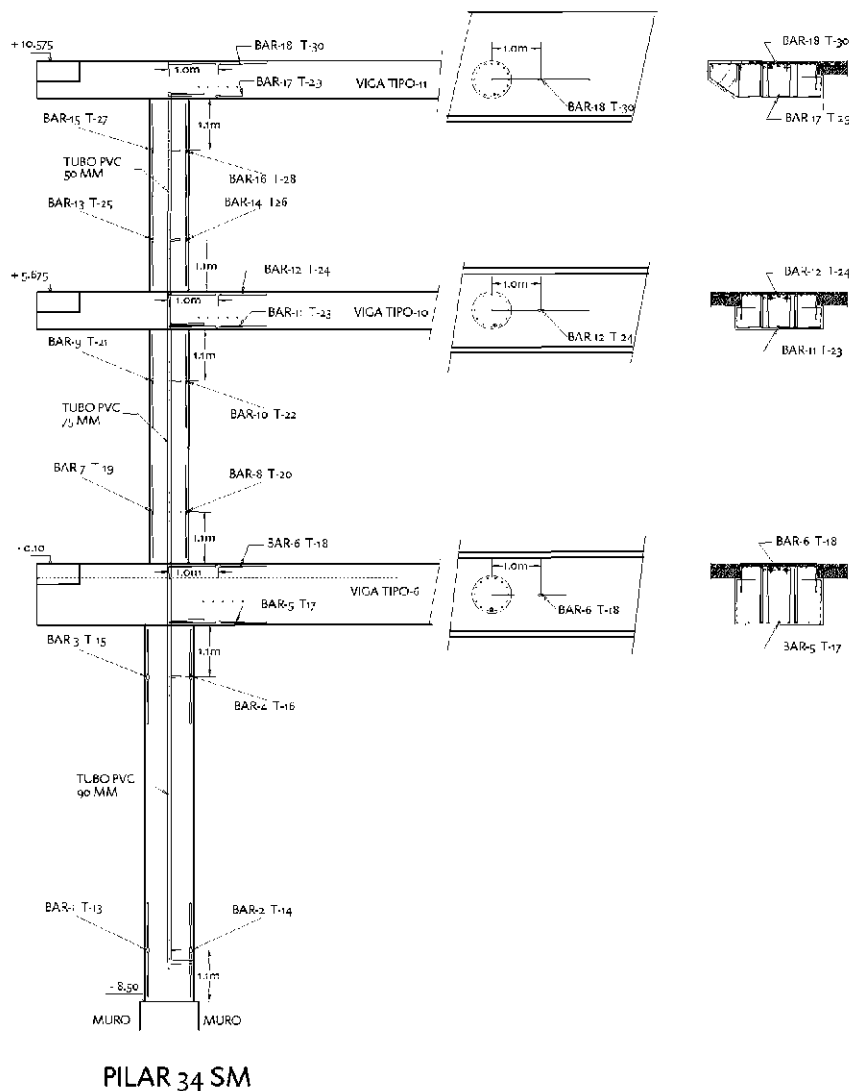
Detalle de la instrumentación del pilar en el extremo del pórtico donde se han utilizado barras instrumentadas.
